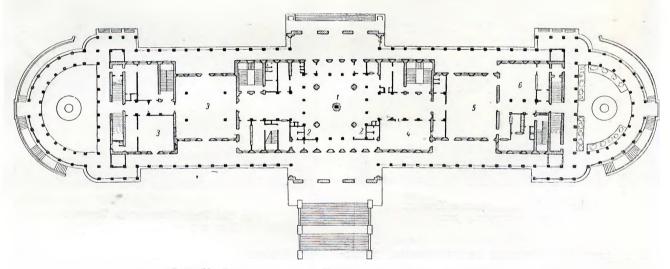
Речной вокзал в Химках. План первого этажа 1—вестибюль; 2—кассы; 3—залы ожидания; 4—агитпункт; 5—ресторан; 6—буфет
